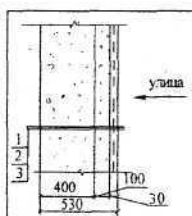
Стена из керамзитобетонных блоков (для жилых помещений):
